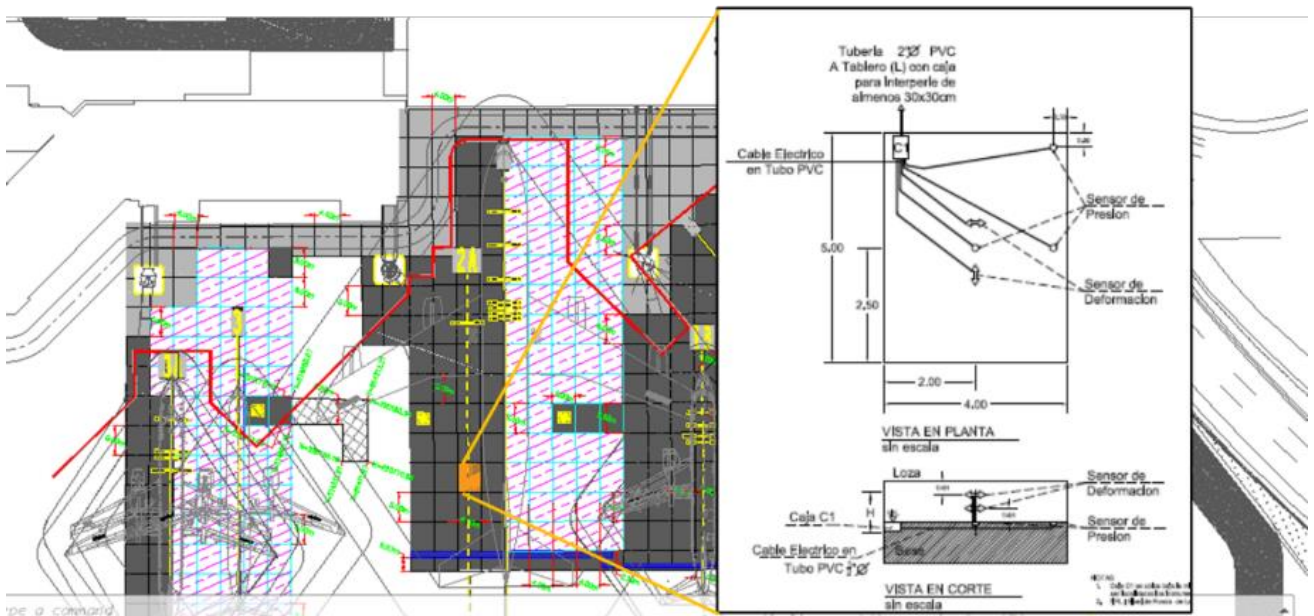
Ubicación de la losa instrumentada, puerta 3 AIJS
